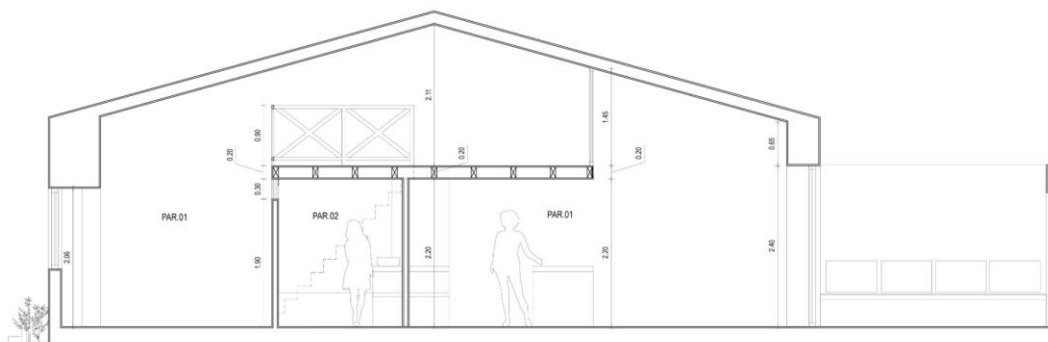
Corte longitudinal da proposta. Projecto 2.
